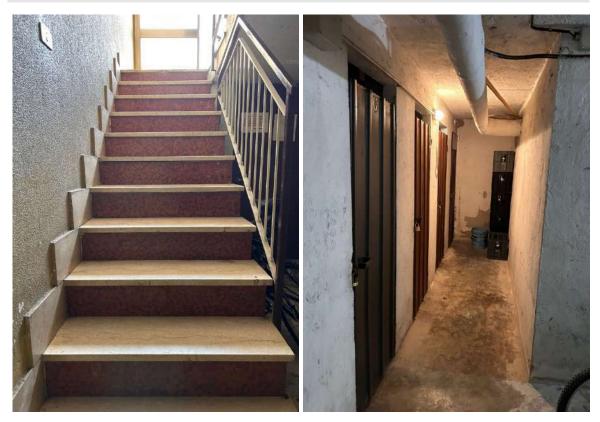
| Scala condominiale di accesso alle cantine e vista del disimpegno.
